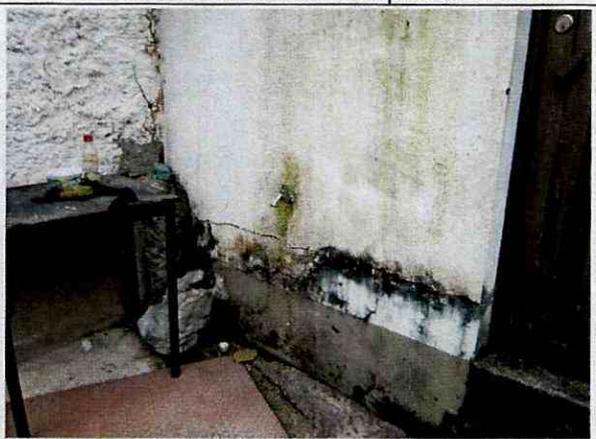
Grietas y deterioro de acabados de muros.
